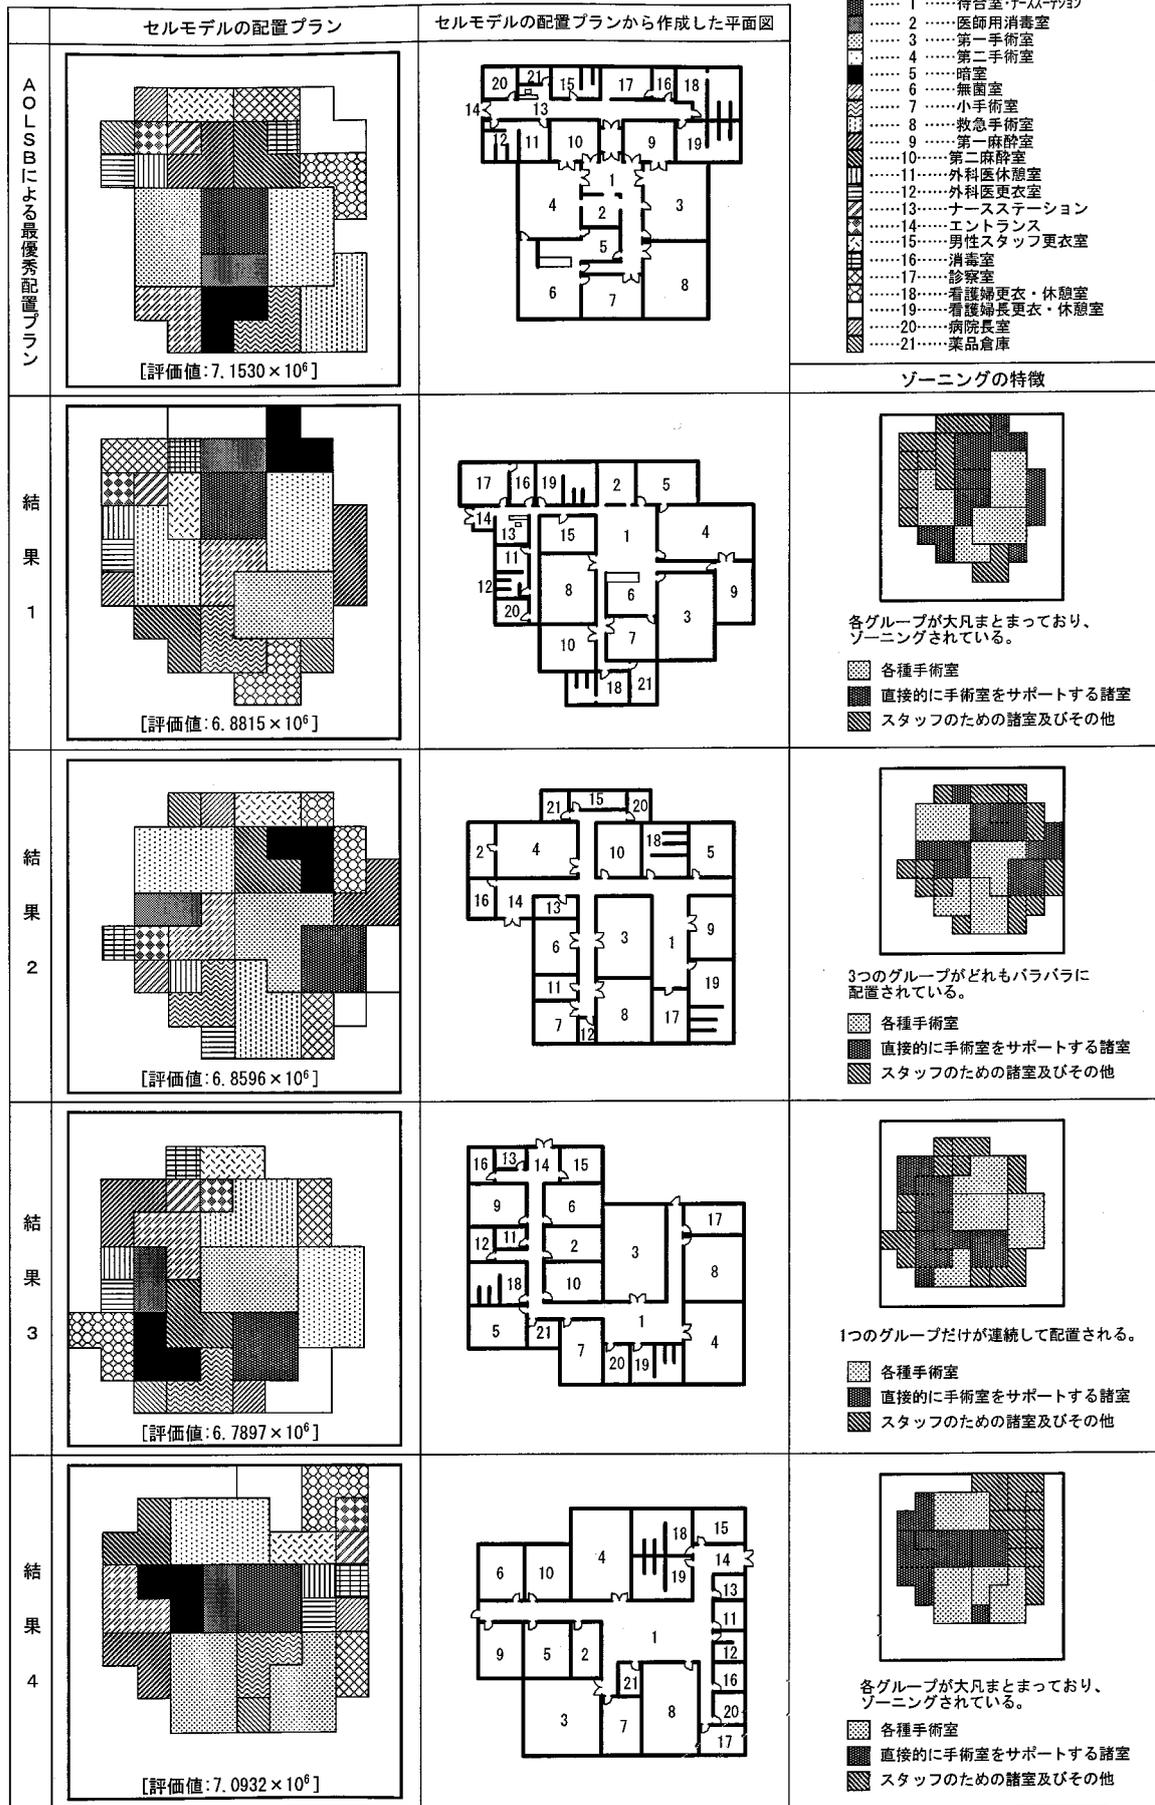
評価の優秀なセルモデルの配置プランとそれをもとにした室配置を示す平面図
